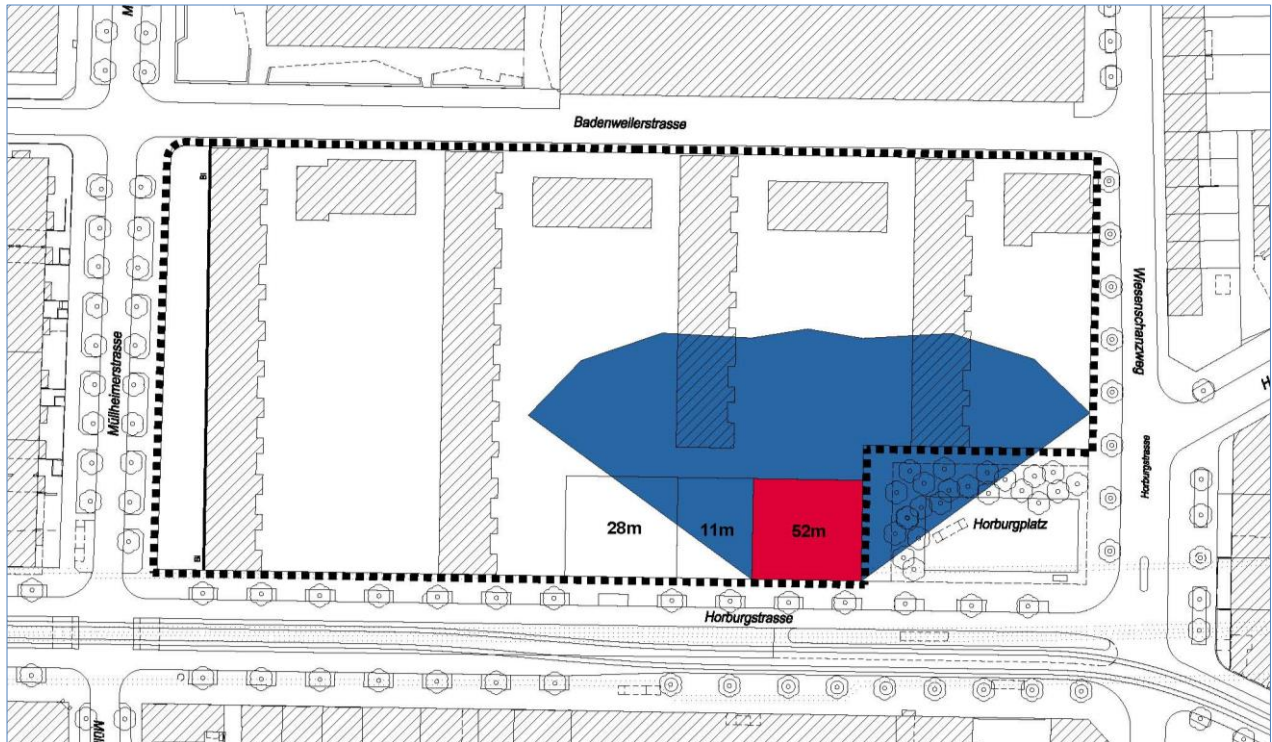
2 Stunden-Schatten Neubau Siedlung Horburg (kein Massstab, Plan genordet)
